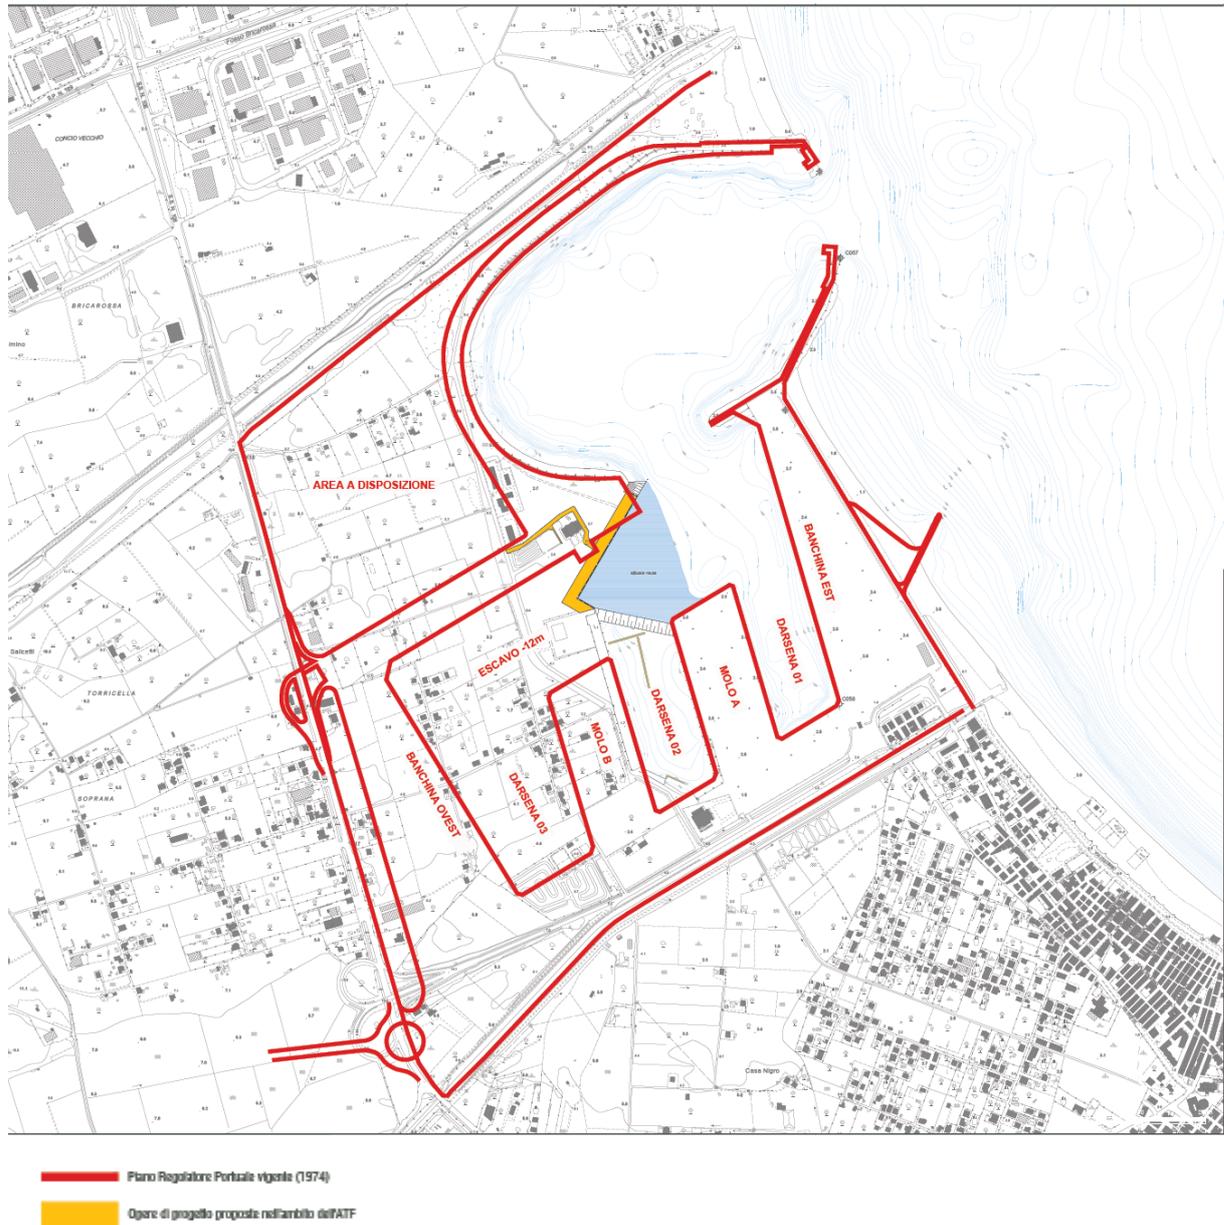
PRP e proposta progettuale nell'ambito dell'ATF (Elab. EG.06)
